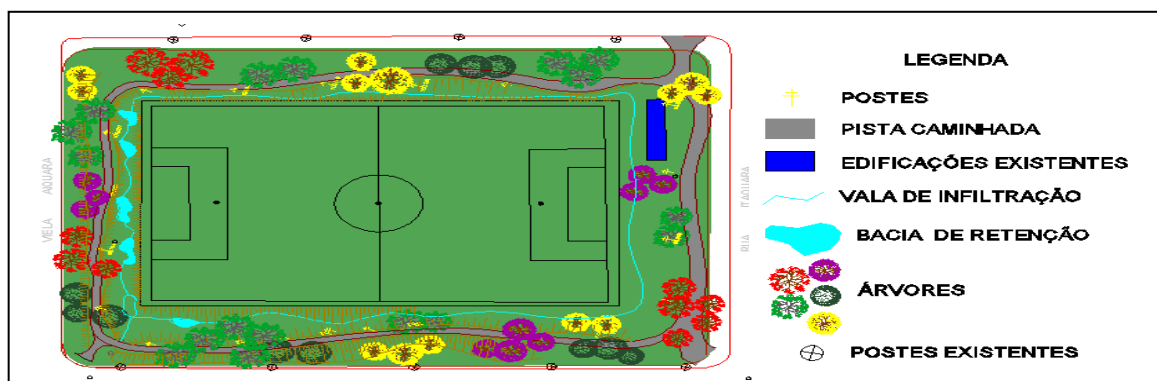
Planta baixa da área de lazer do Campo do Caxias.
